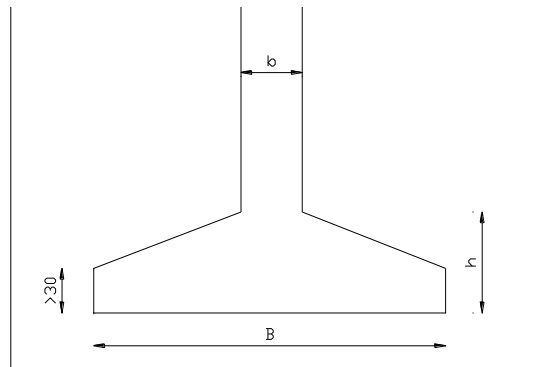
Zapata de Hormigón Armado, Valverde J. (1997)
